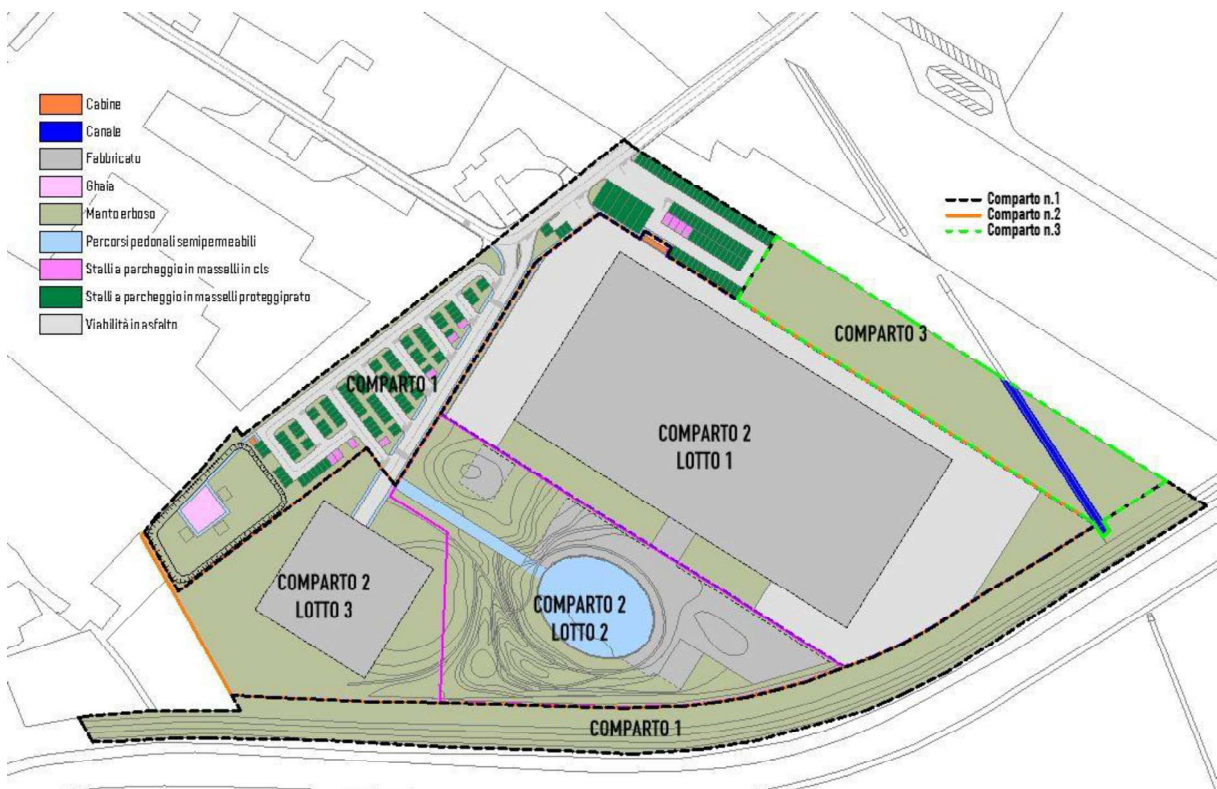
Suddivisione di dettaglio in aree a diversa permeabilità
